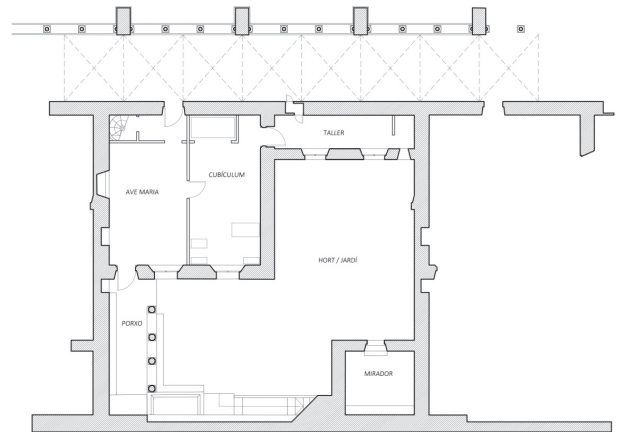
Levantamiento de una celda tipo de la primera época de construcción de la cartuja (s.XV). Planta baja.
